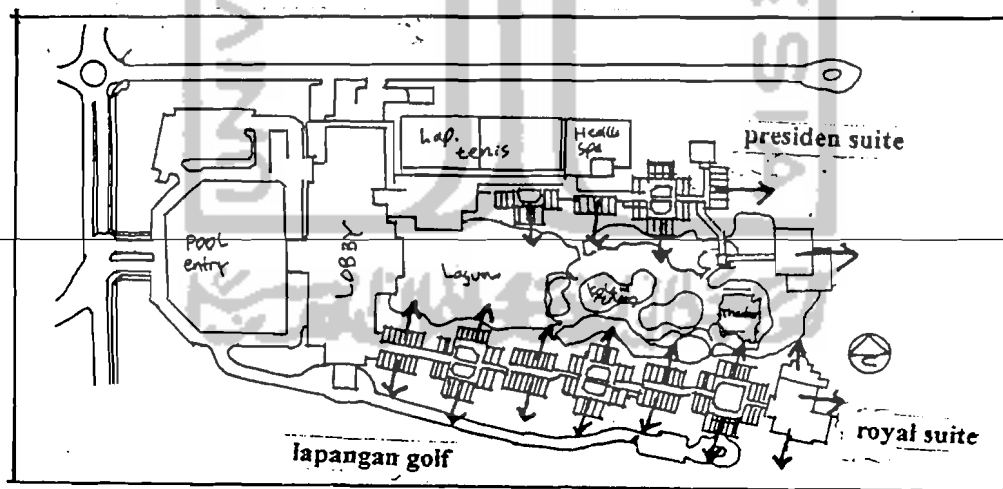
Site plan Bali Hilton Int'l Hotel, Nusadua, Bali
